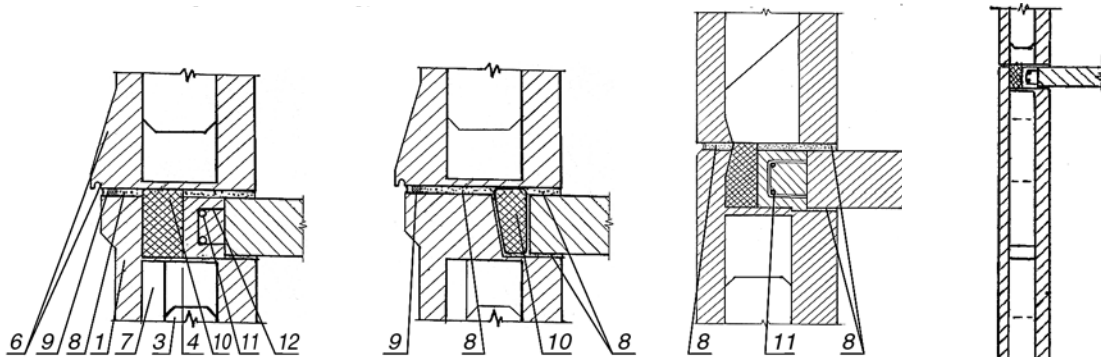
Варианты исполнения горизонтального стыка цокольной панели с наружным и внутренним несущими слоями с рядовой панелью наружной стены 1-го этажа: обозначения 1–7 аналогичны рис. 1–4; 8 – растворный шов; 9 – гидроизоляционный участок; 10 – утепляющий вкладыш; 11 – монолитный железобетонный участок с непрерывной горизонтальной арматурой; 12 – петлевые выпуски из плит перекрытия
